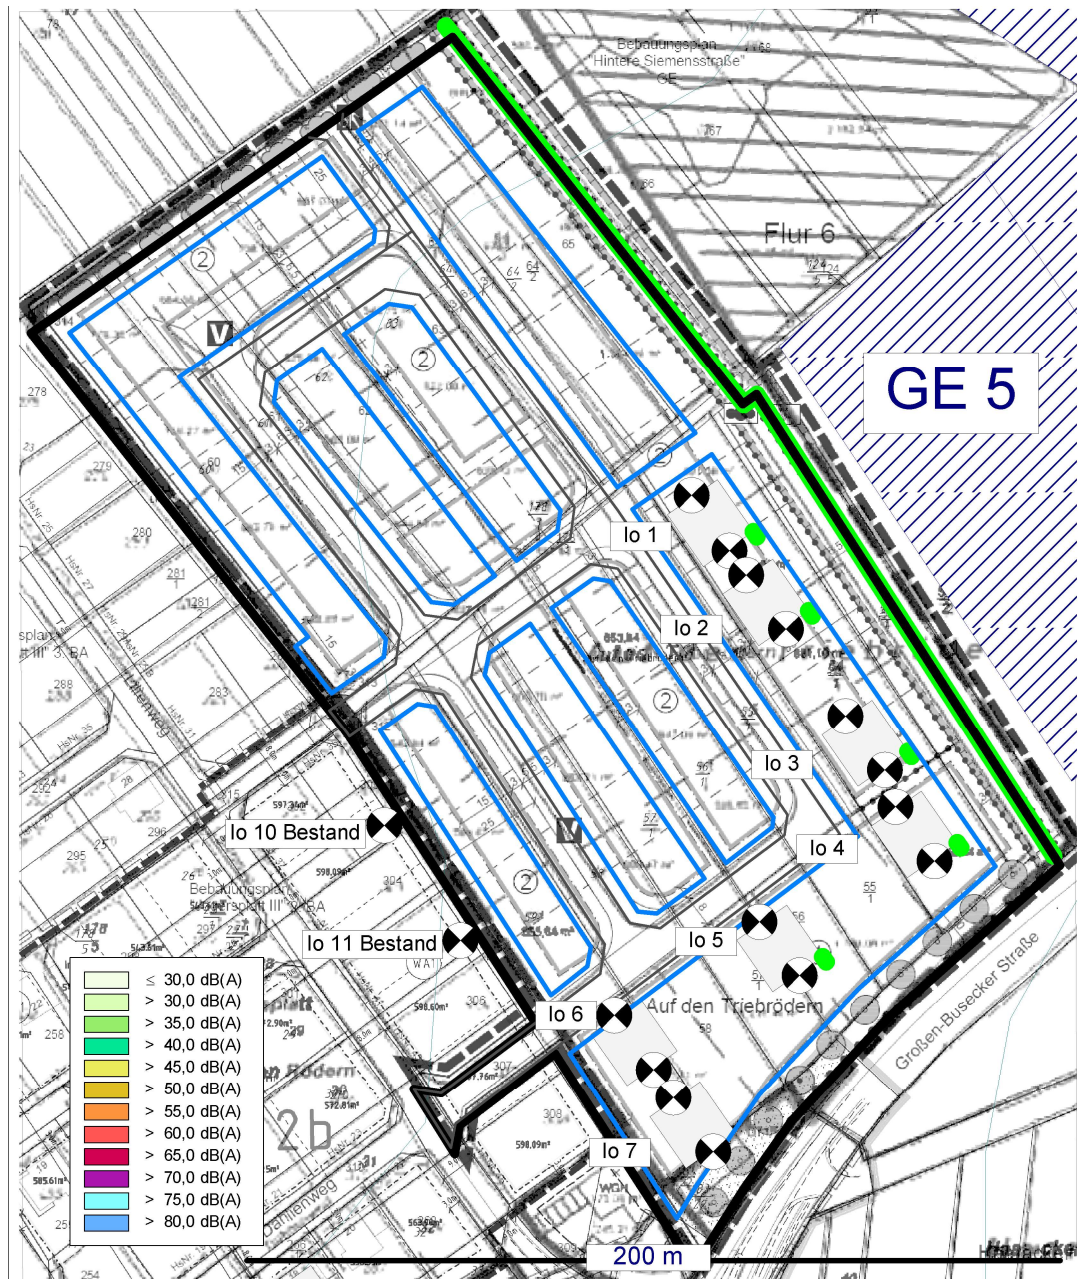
Lageplan mit Kennzeichnung der Immissionsorte.
